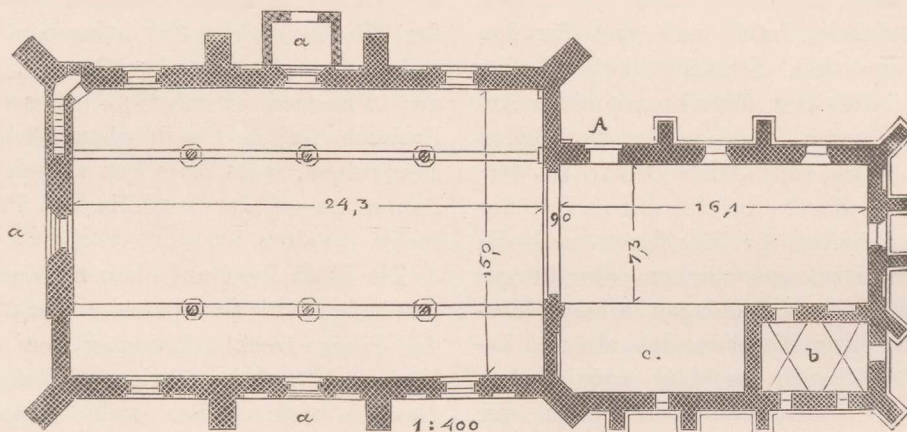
Lessen. Grundriss der kathol. Pfarrkirche.
